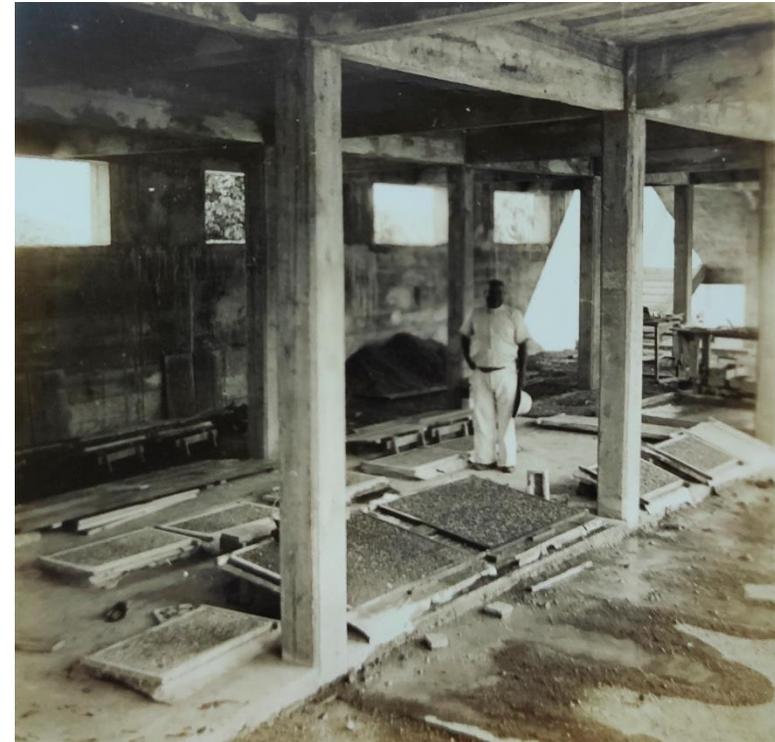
Processo de fabricação das placas de revestimento da fachada.
